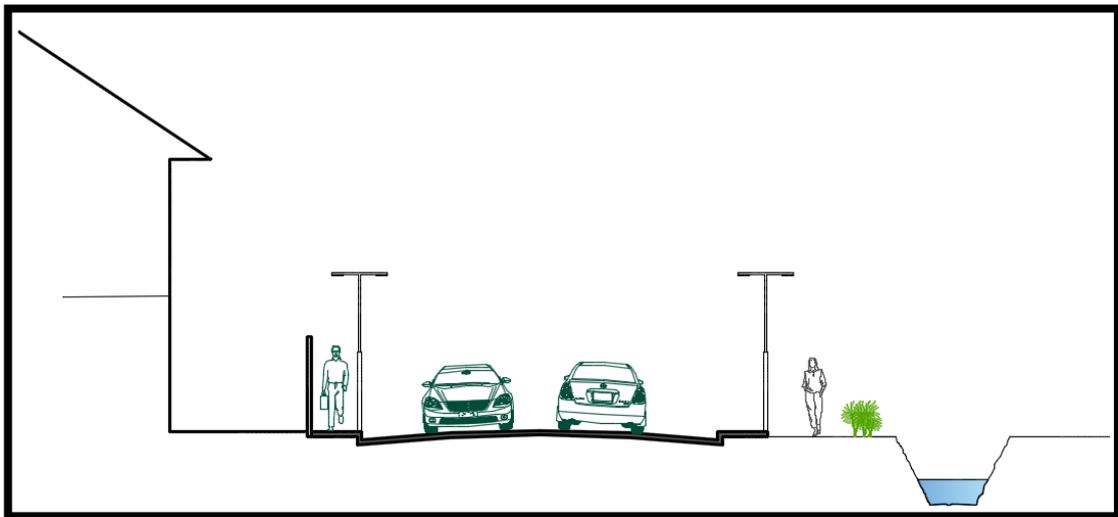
CORTE DE LA CALLE LONGITUDINAL CON SECCIÓN DE 10m
